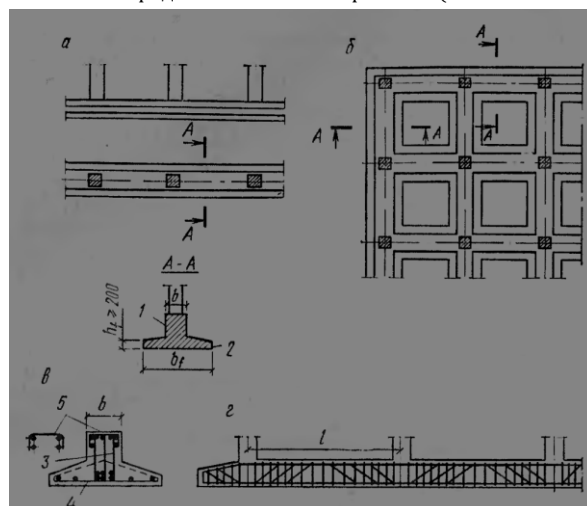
Ленточные монолитные фундаменты под колоннами
